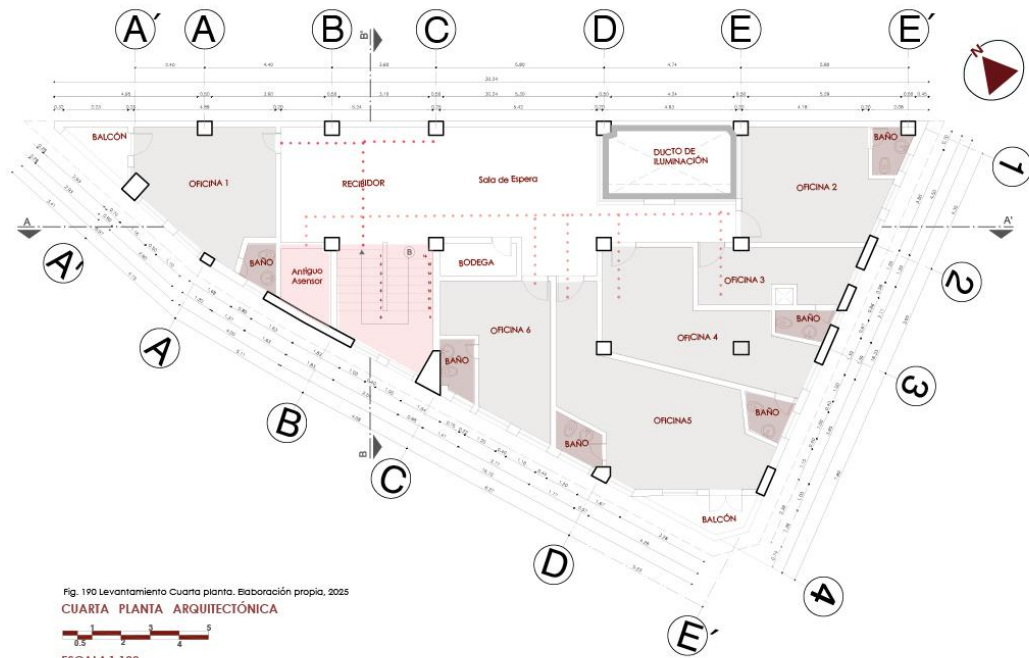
Levantamiento Cuarta planta. Elaboración propia, 2025
